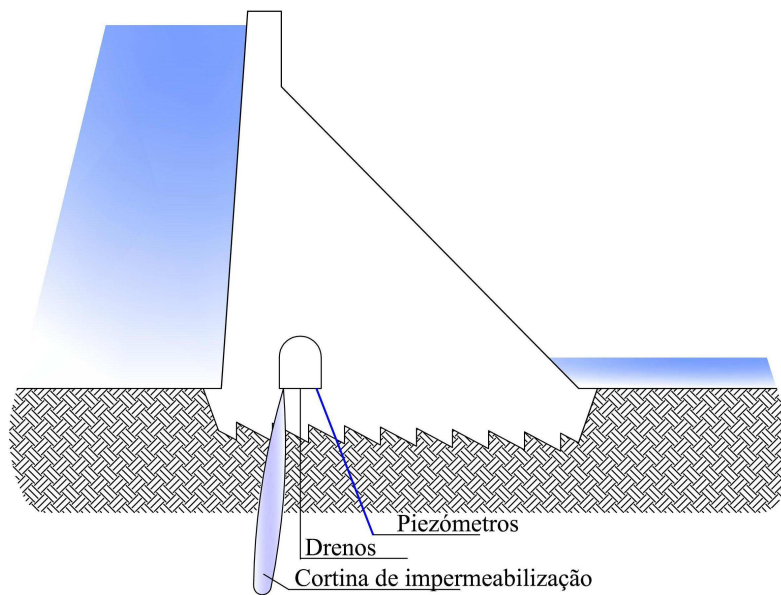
Cortina de impermeabilização, rede de drenagem e piezômetros executados a partir da galeria.
